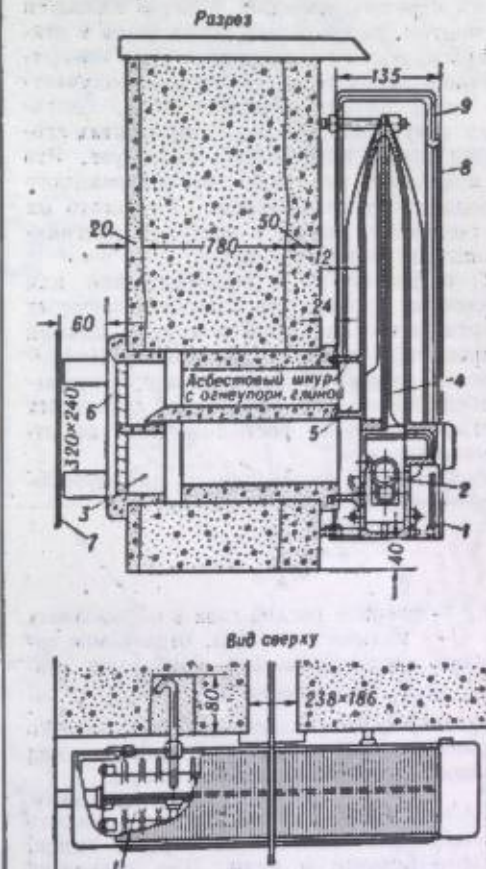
Газовый нагревательный прибор с изолированным от помещения газоходом: 1 — корпус-нагреватель; 2 — инжекторная трубчатая горелка со съемной фронтальной плиткой; 3 — отверстие для притока наружного воздуха; 4 — перегородка; 5 — отверстие для выхода продуктов сгорания; 6 — короб в наружной стене; 7 — противотетровый щиток; 8 — защитный кожух; 9 — отверстие для выхода горячего воздуха.
